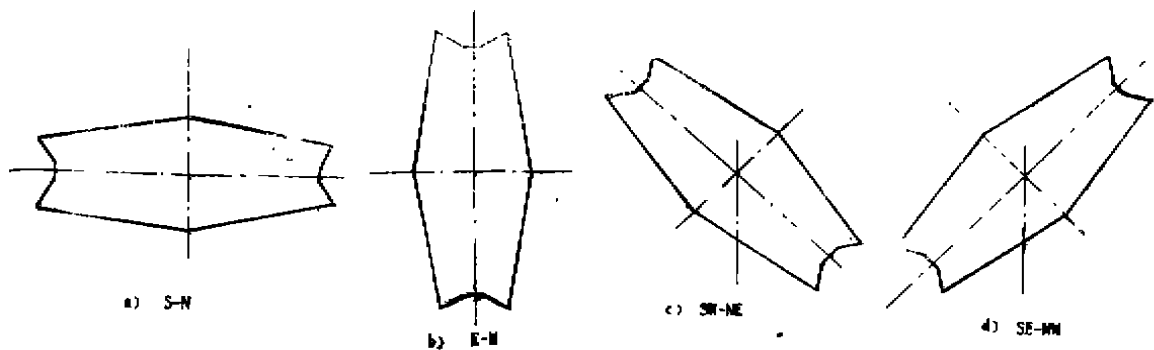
广州某宾馆主楼四种不同方位的标准层平面图
